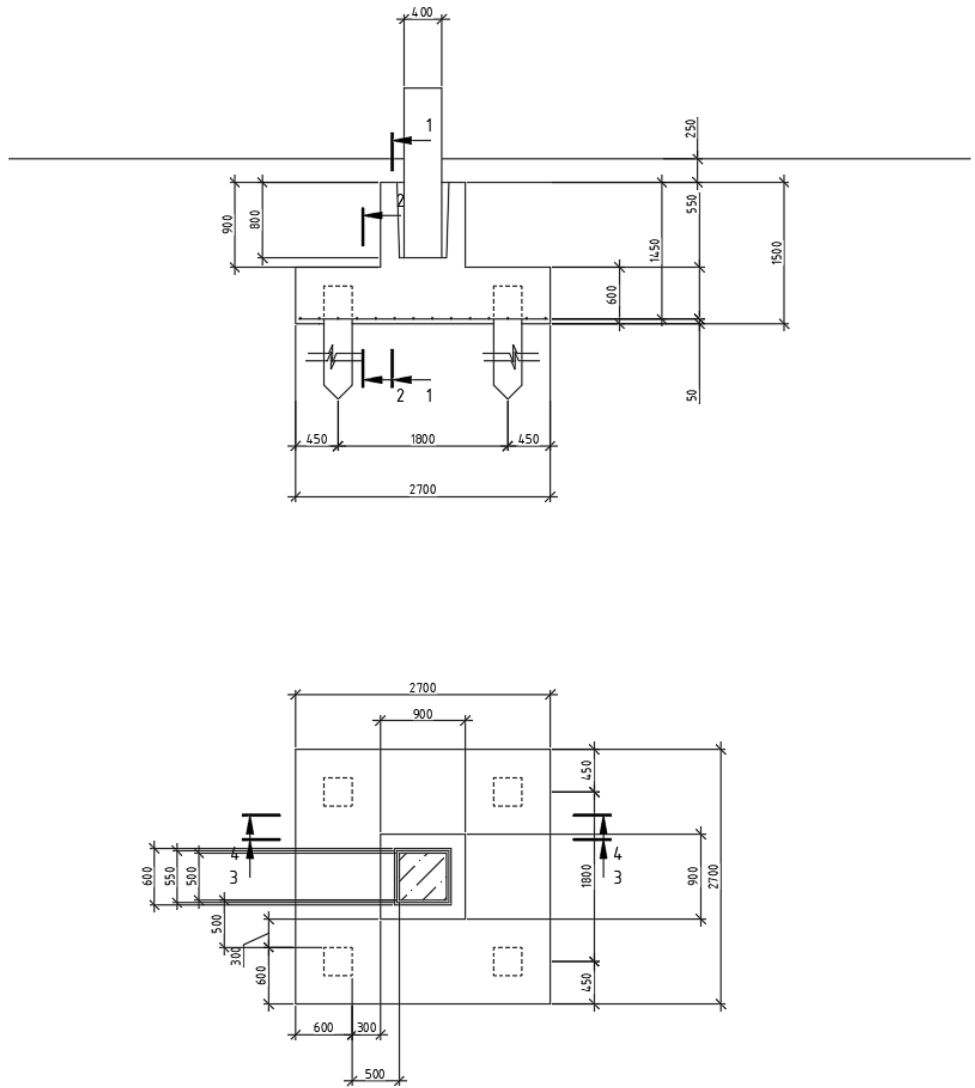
Свайный фундамент под сборную железобетонную колонну
